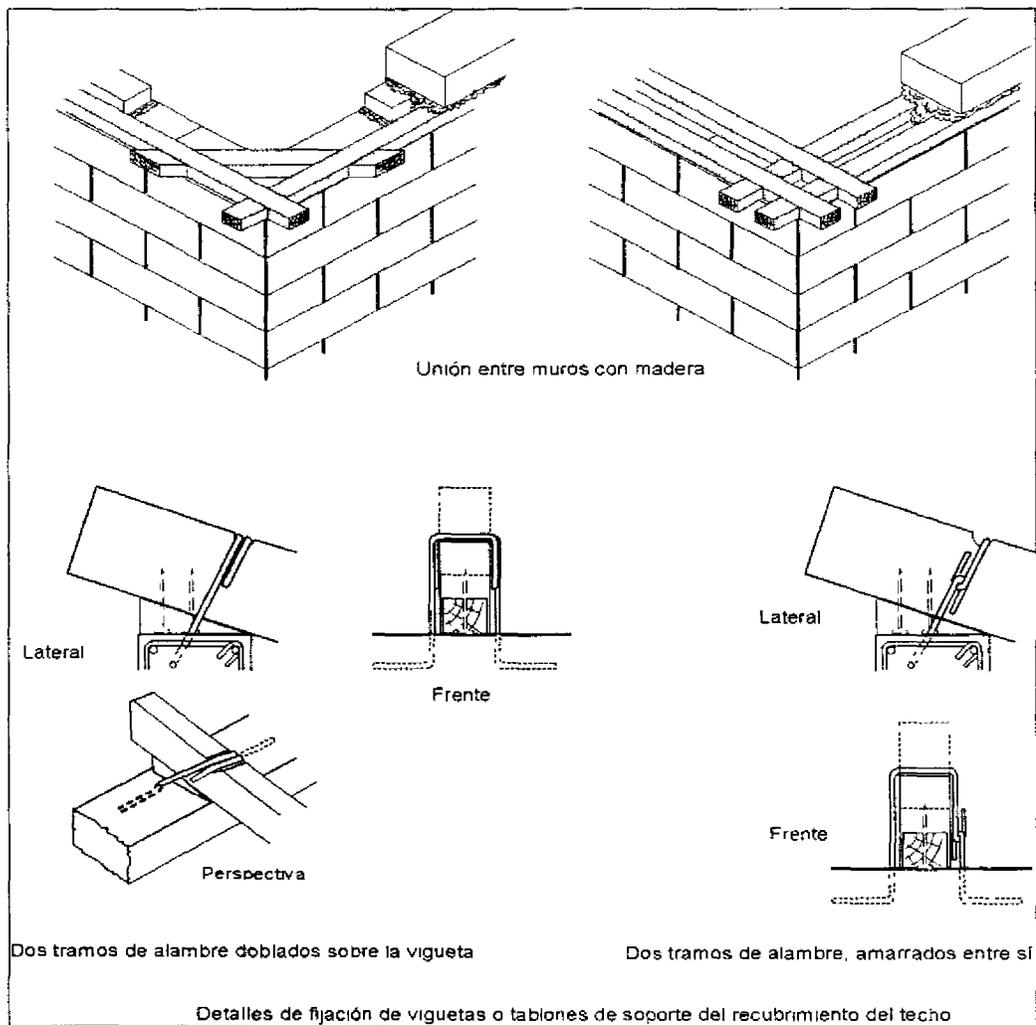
Detalles de liga entre muros y de anclaje de los elementos soporte de techo
